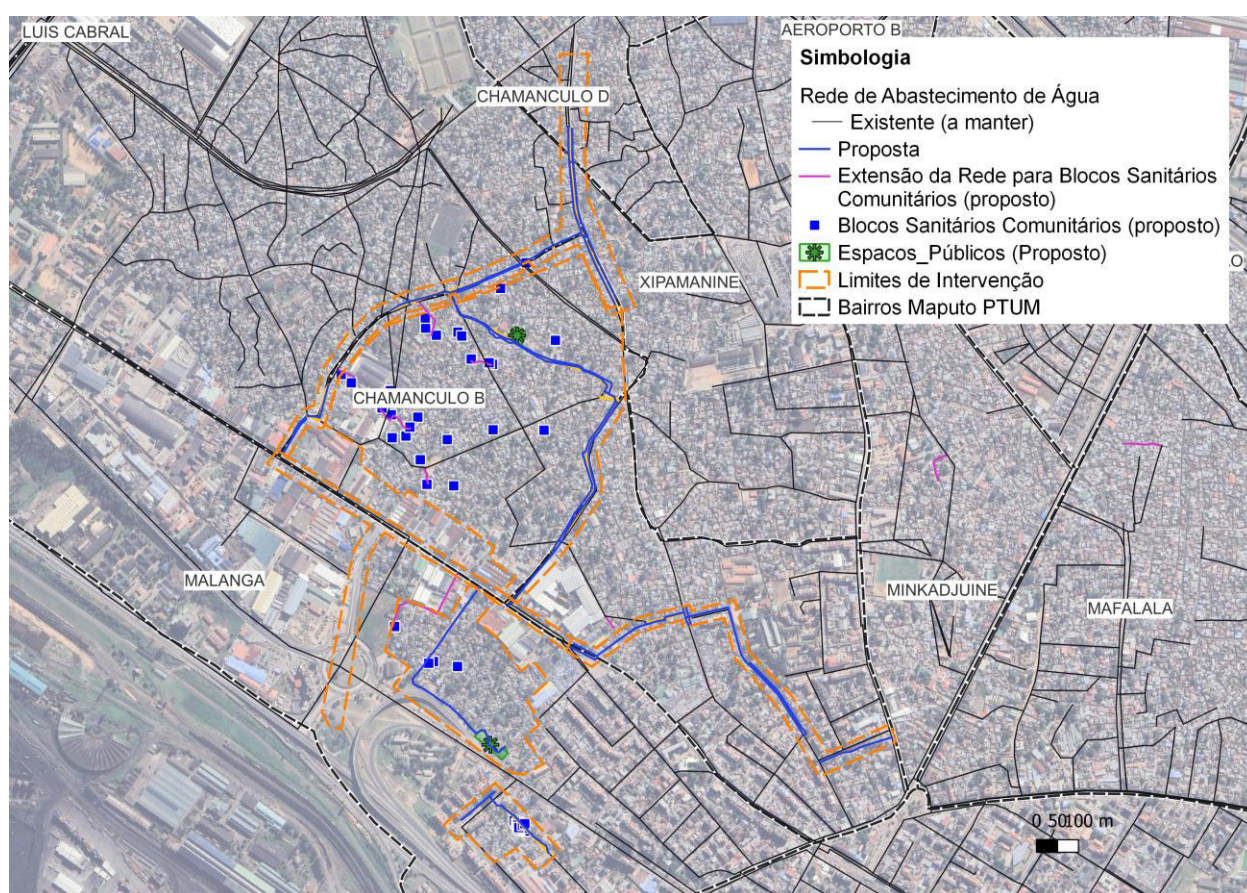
Localização prevista das condutas a construir no âmbito do pacote de intervenção da Fase 1 - Pacotes 9A e 9B (as intervenções do P9B não constam do presente documento).
